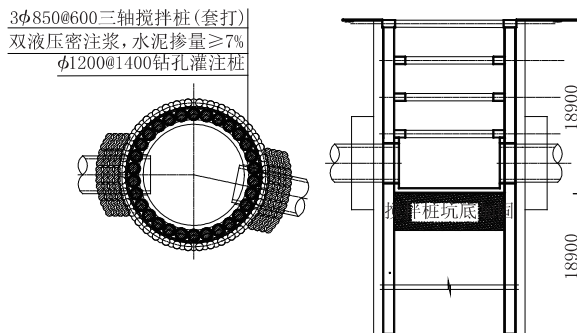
已施工完成的顶管井平、剖面图(兼作工作井和接收井)(单位:mm)
